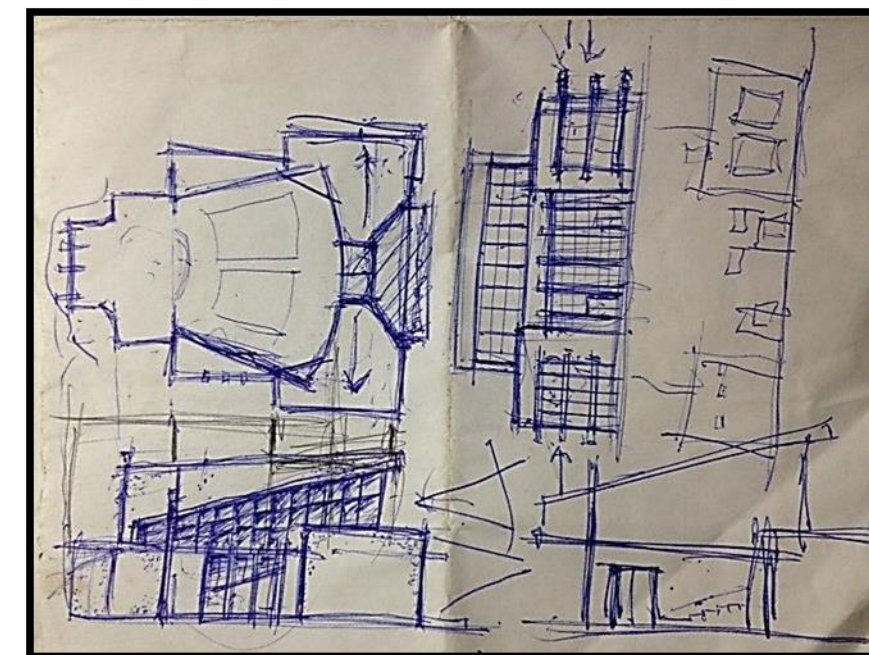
diseño de fachadas y planta templo. Fuente propia
